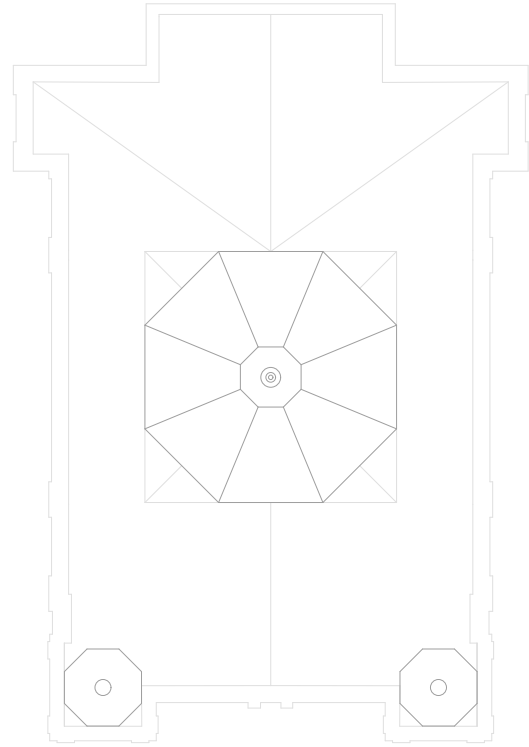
ArchiCAD Modell - Dachdraufsicht
